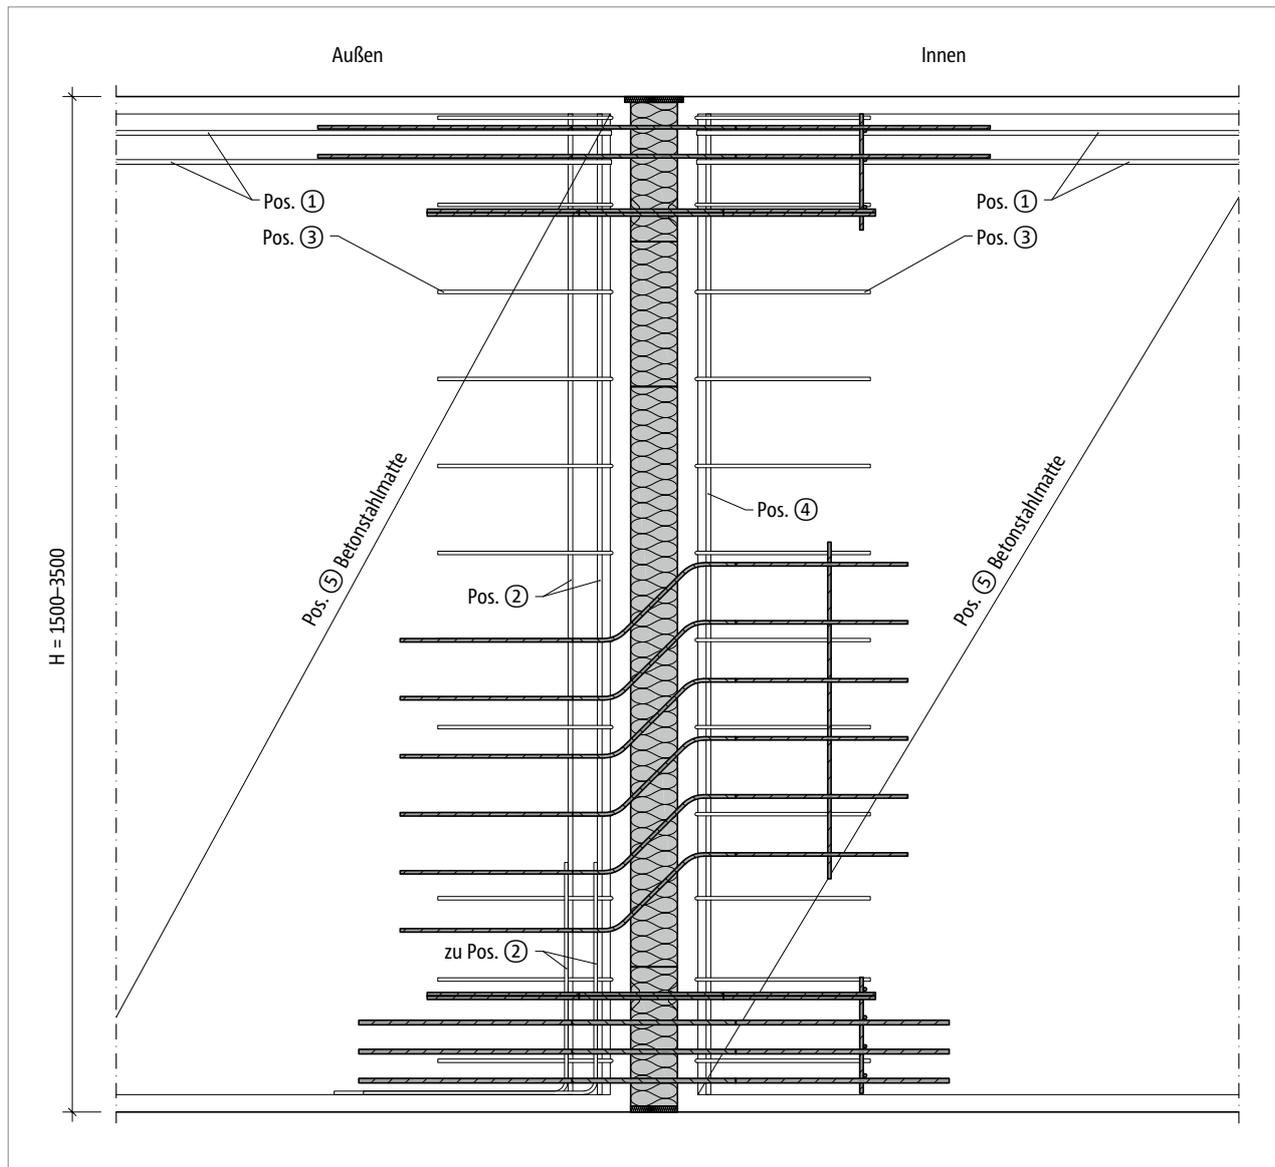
Schöck Isokorb® T Typ W: Bauseitige Bewehrung; Schnitt
